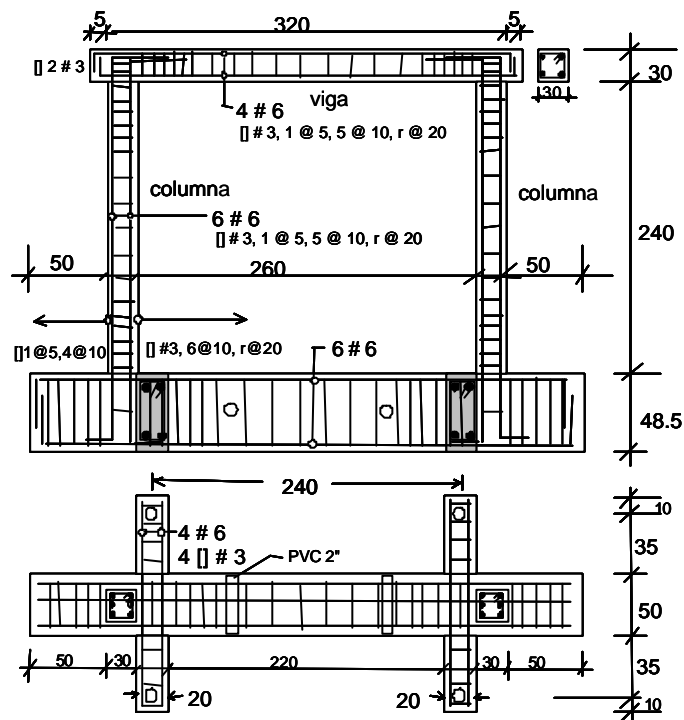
Dimensiones (cm) y refuerzo del pórtico de concreto armado.
